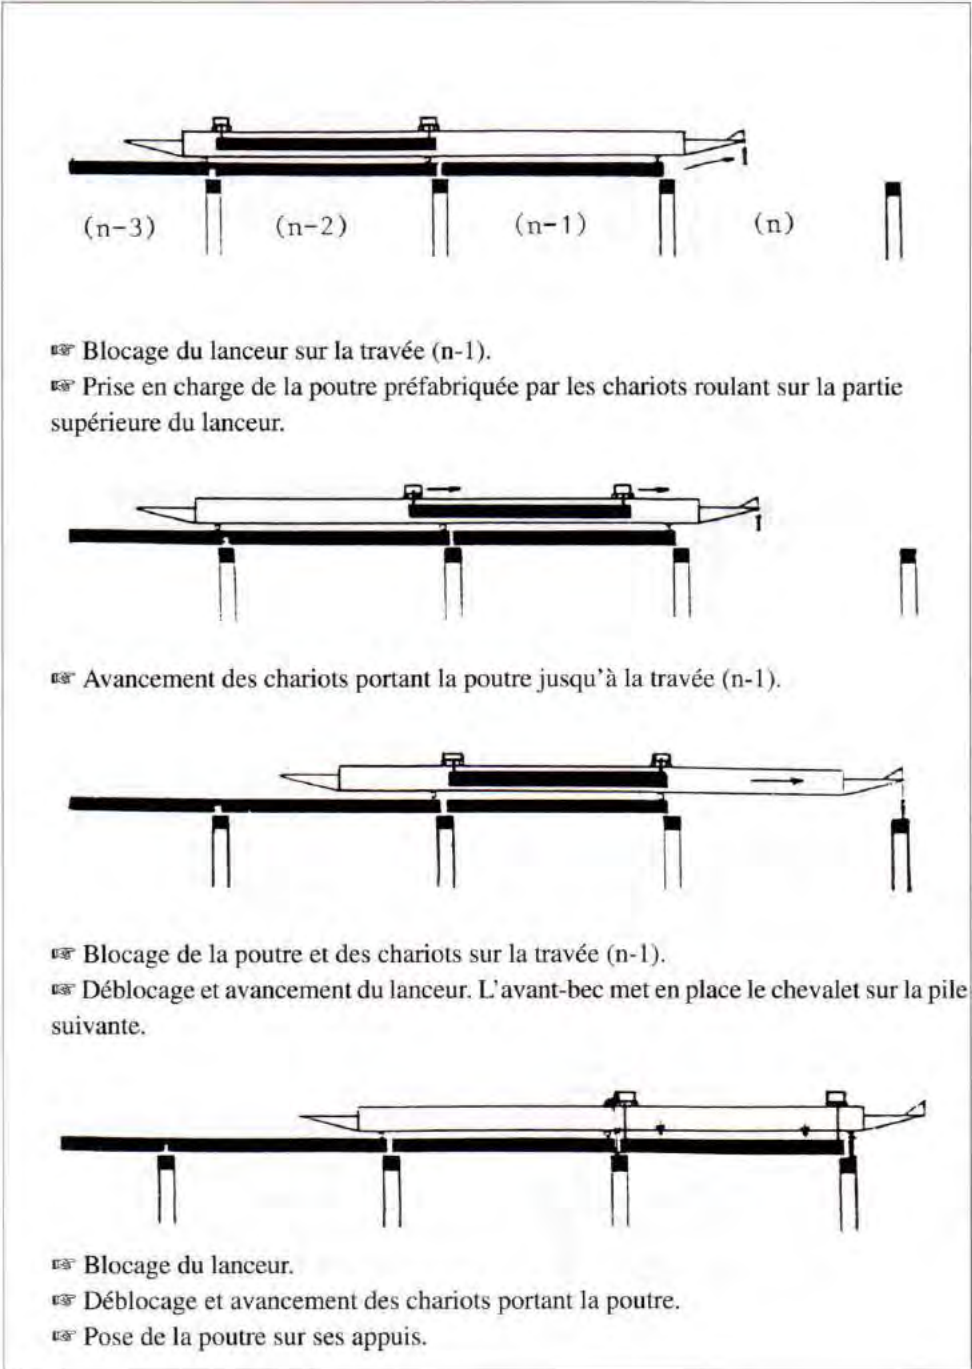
Exemple de lancement d'un pont à poutres.
